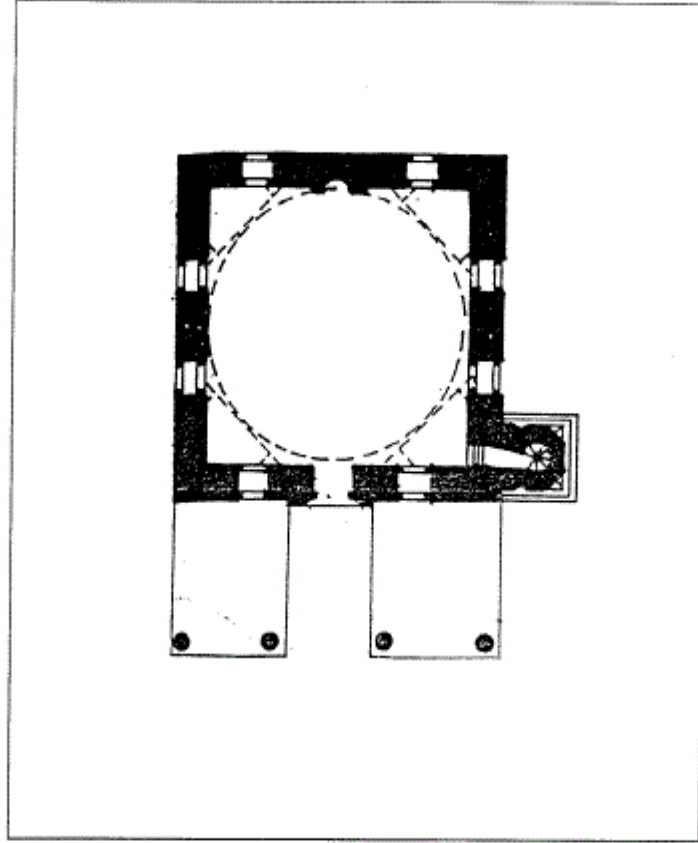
مسقط أفقي لمسجد خداوندكار في بهرام قلعة (عن : كوران) .
